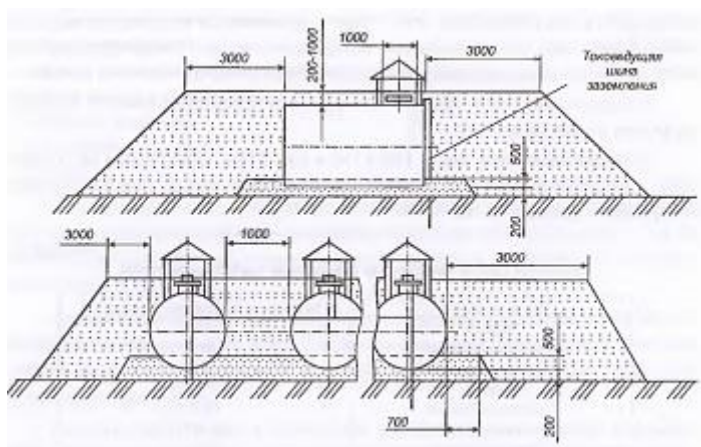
Схема заглубленной установки стальных горизонтальных резервуаров
